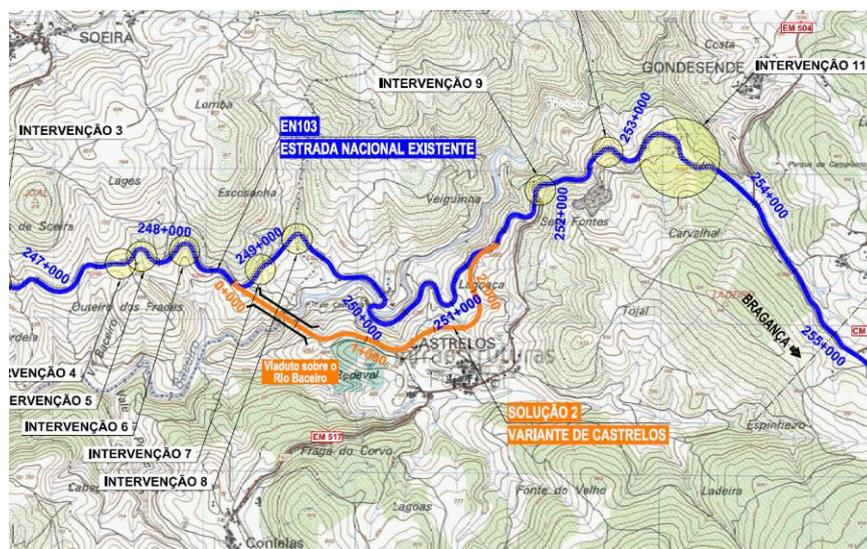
Implantação da Variante de Castrelos – Solução 2
